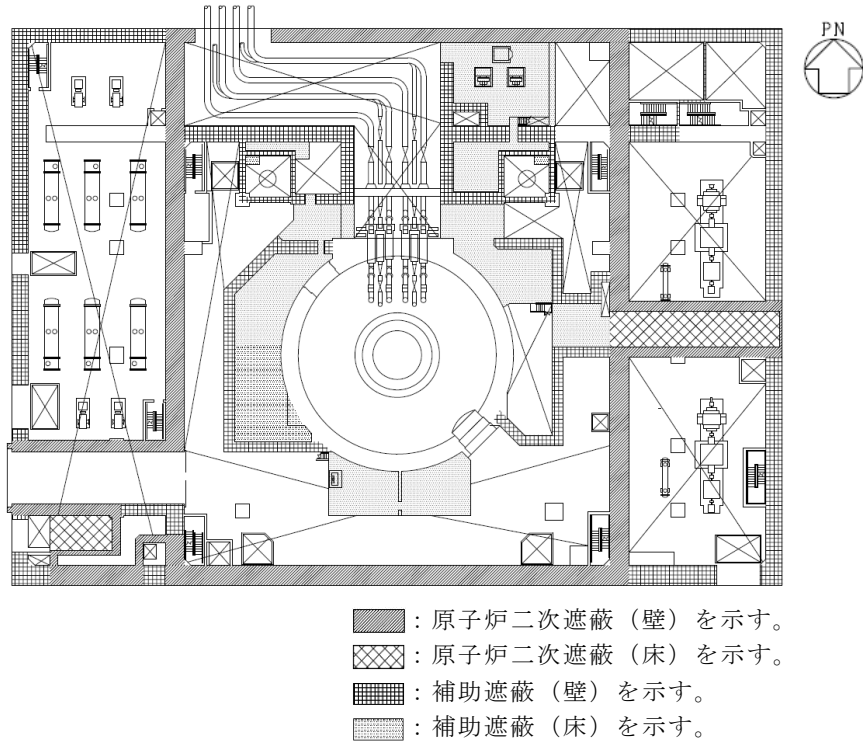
(5) 原子炉二次遮蔽及び補助遮蔽（原子炉建物）の範囲の平面図
